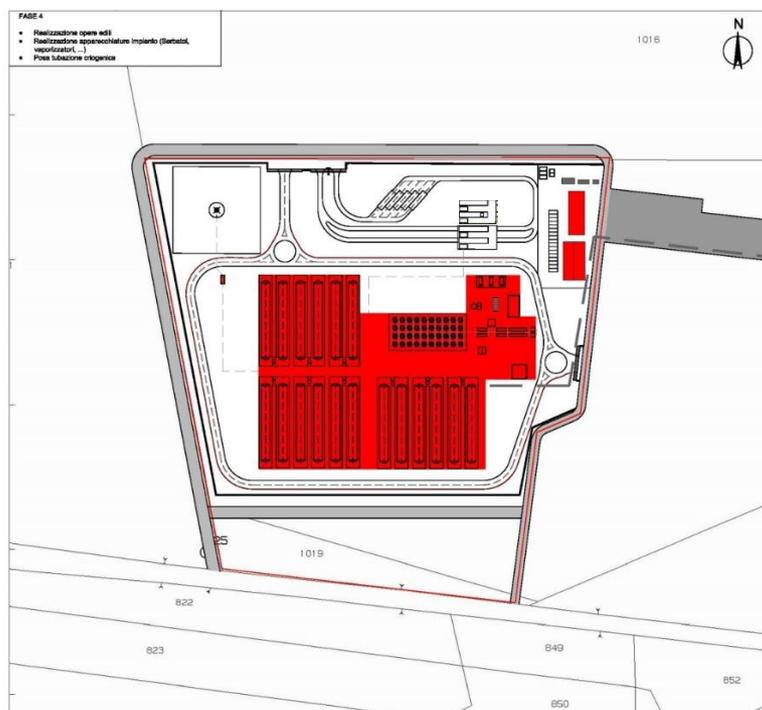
Fase 4 Area oggetto delle lavorazioni previste.
